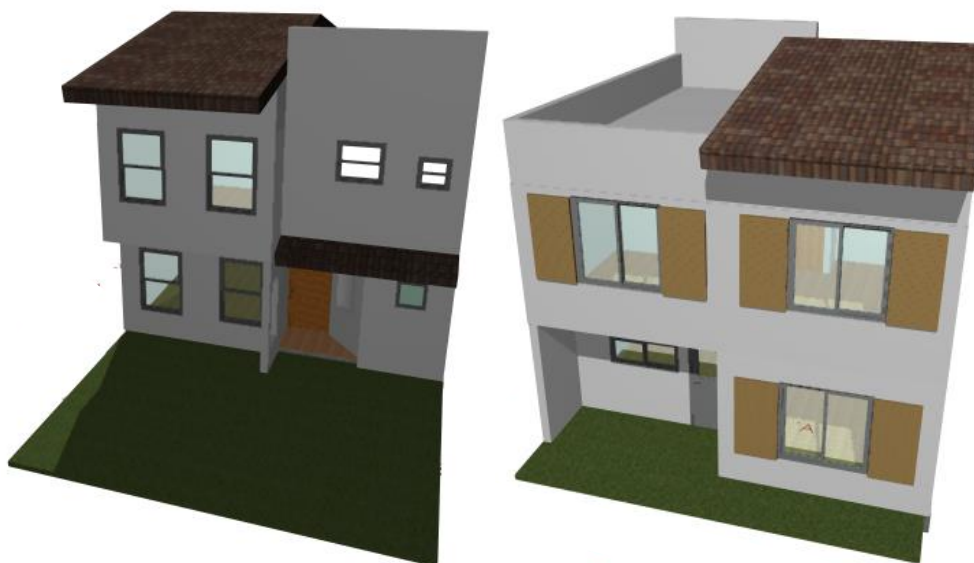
Fachada principal y fachada posterior con orientación sur (diciembre 21). Imagen E.P.
